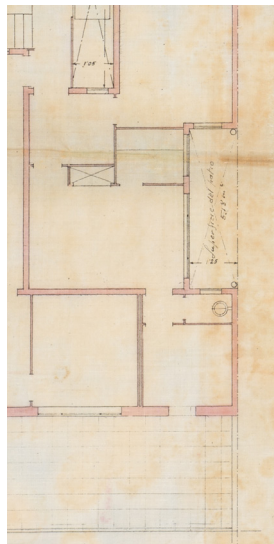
Detalle del plano original de Roselló 36. Vivienda que se identificaría con las fotografías facilitadas por Fincas Lluria. No aparece división de la terraza de las viviendas de la 6 planta
